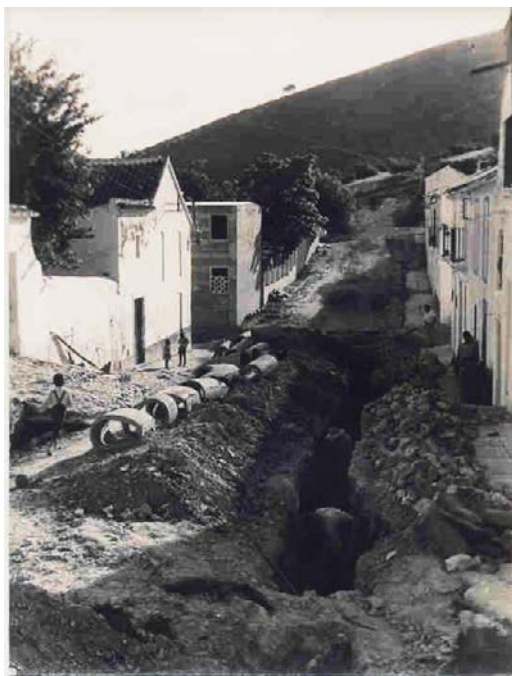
Instalación del alcantarillado en la calle Ramón y Cajal, en 1962. (Fondo de la ACEI).
